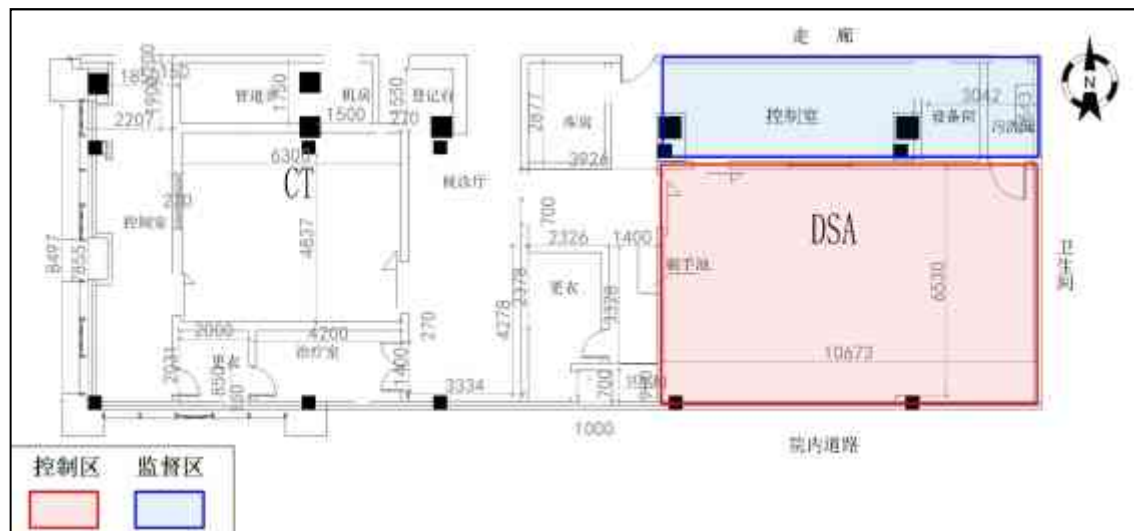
北院门诊楼一层急诊DSA机房平面布置及分区示意图
